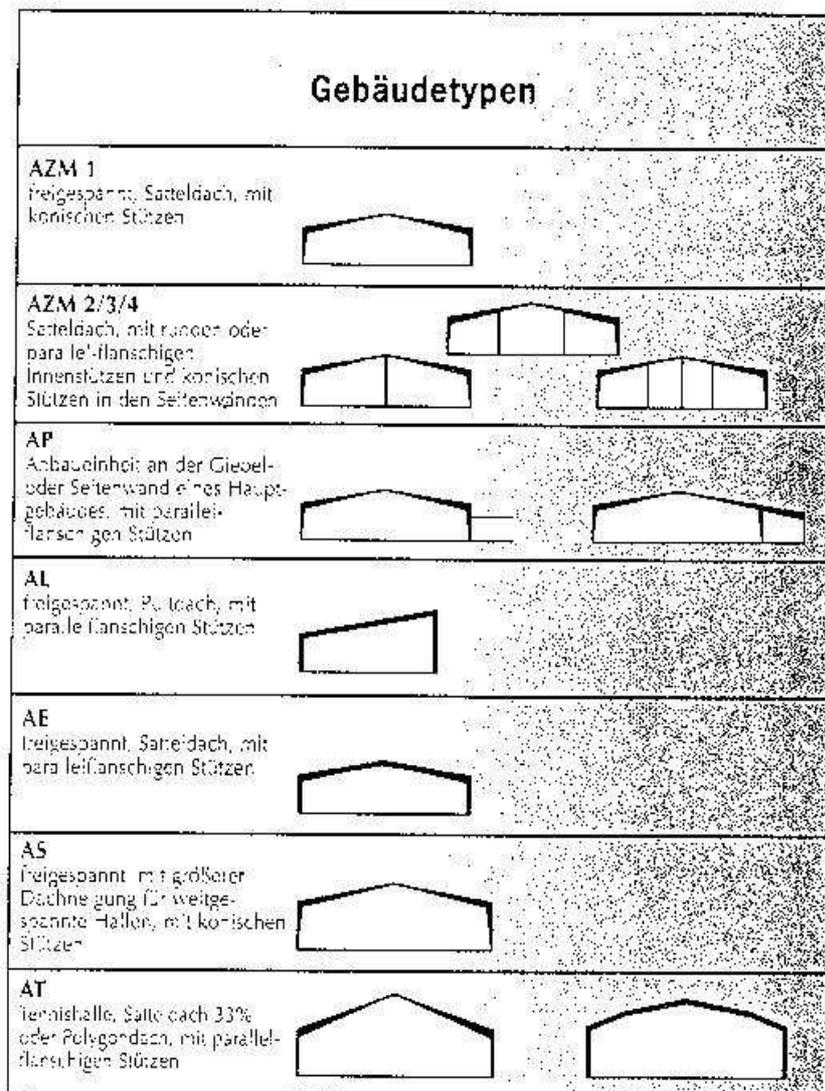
Gebäudetypen (Werkbild Astron Hallen + Bausysteme)
